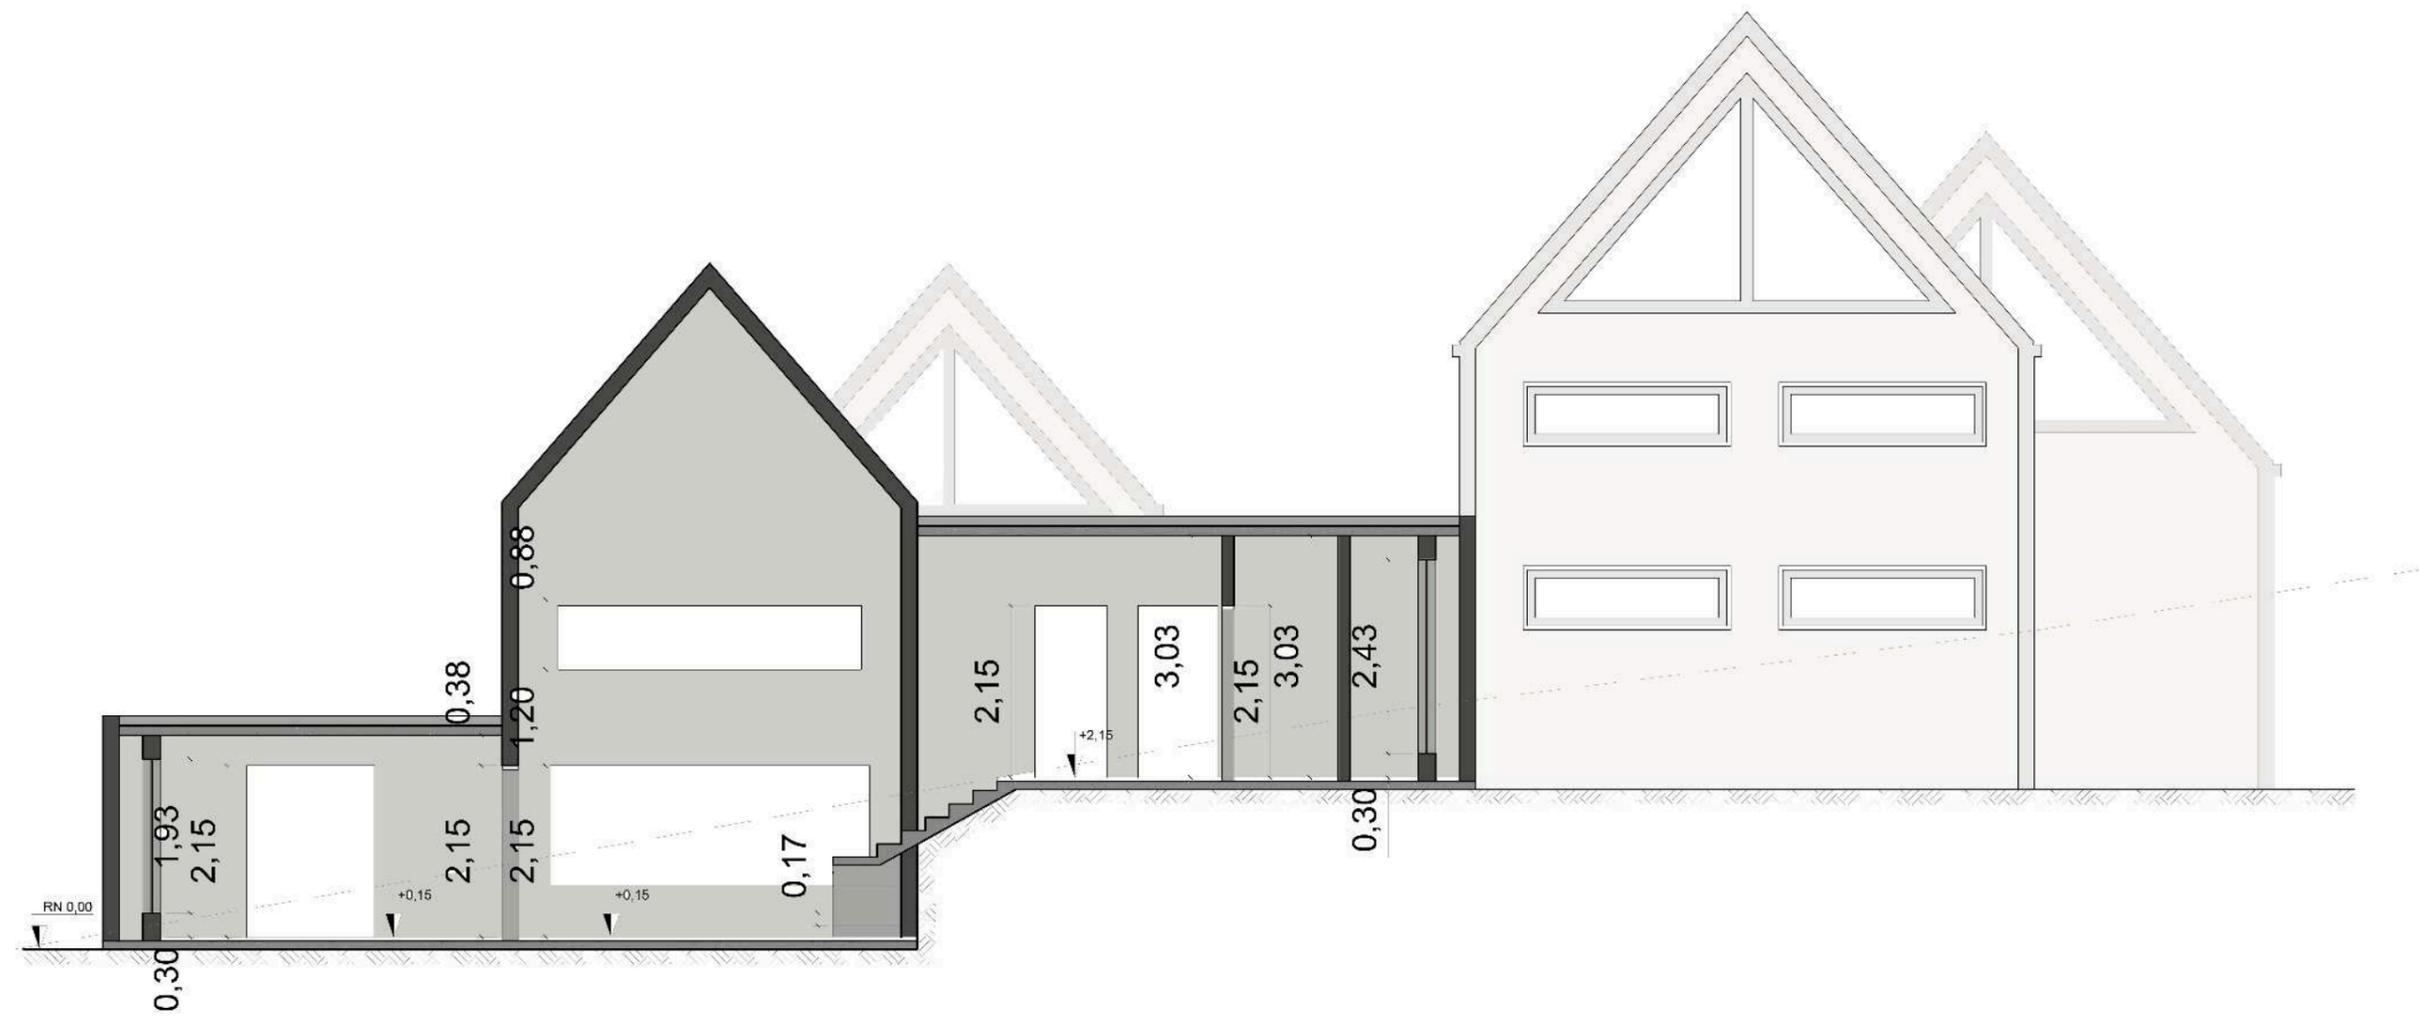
Corte AA e Planta de Cobertura do Complexo UC
